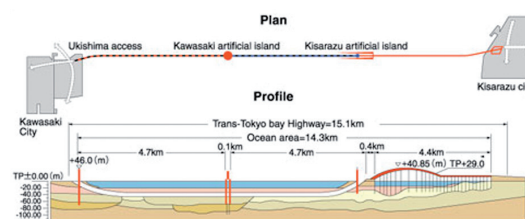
da [13] – Pianta e profilo progetto Aqualine.
